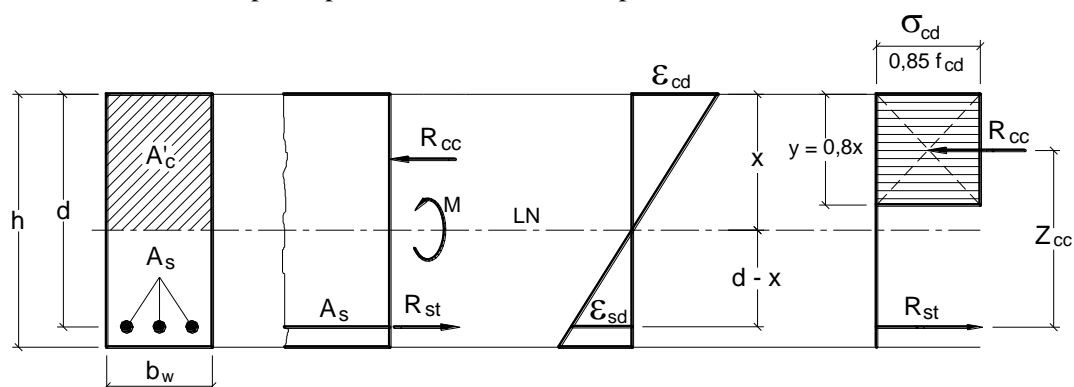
Distribuição de tensões e deformações em viga de seção retangular com armadura simples, para concretos do Grupo I.
